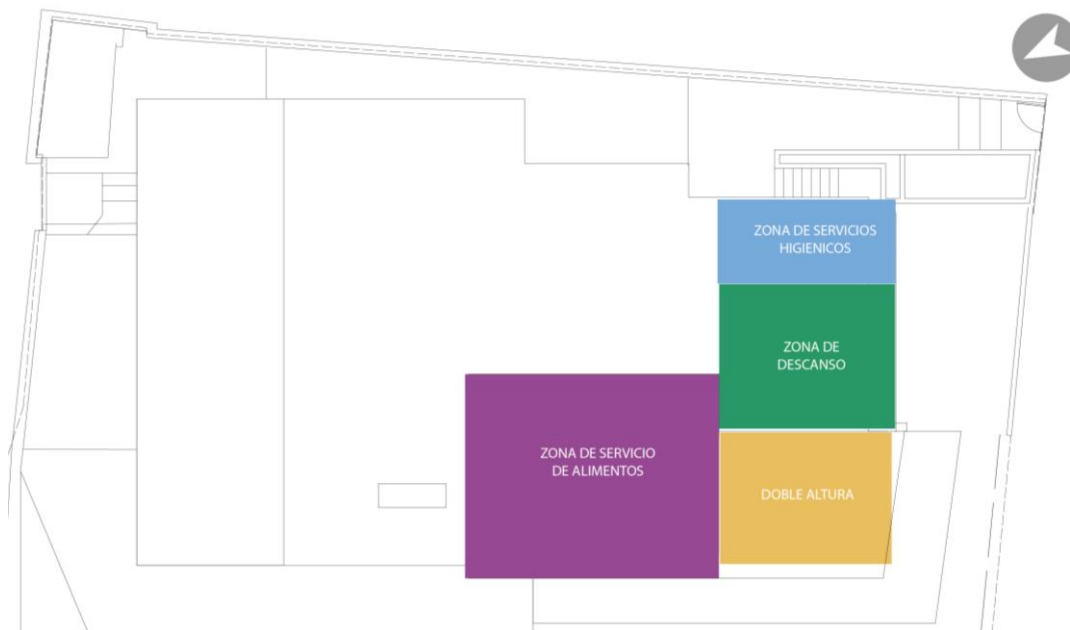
ZONIFICACIÓN SEGUNDA PLANTA
